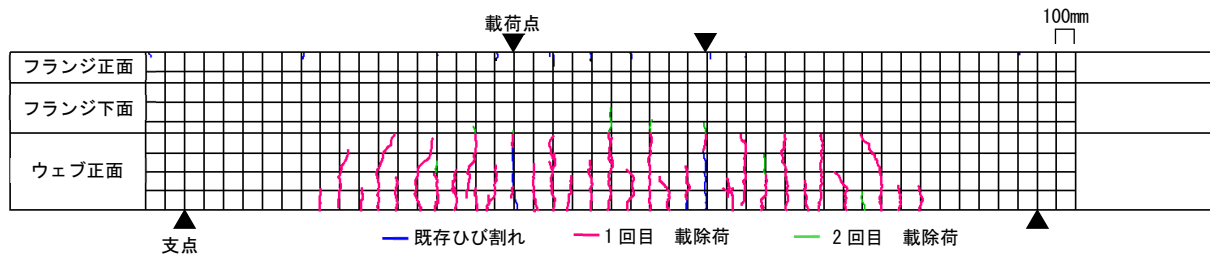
Step2におけるひび割れ図（試験体 L）
